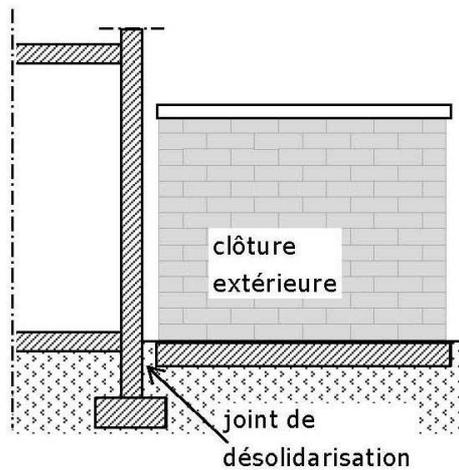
Désolidarisation des fondations des ouvrages secondaires
